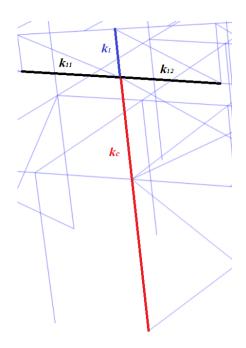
Coeficientes de rigidez del pilar de la fachada.
